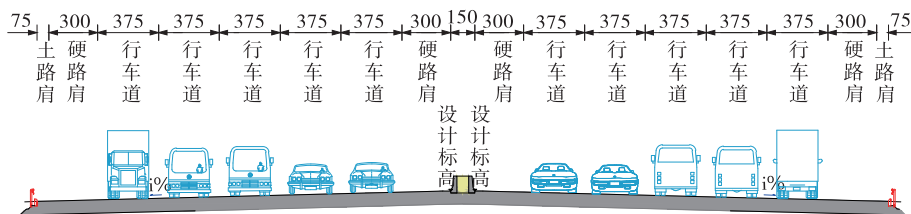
依托工程扩建后横断面布置示意图(单位:cm)
